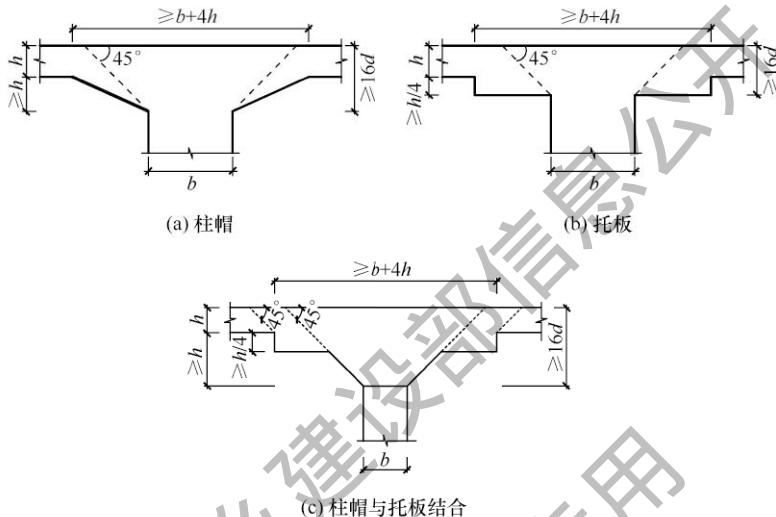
带柱帽或托板的板柱节点冲切示意
